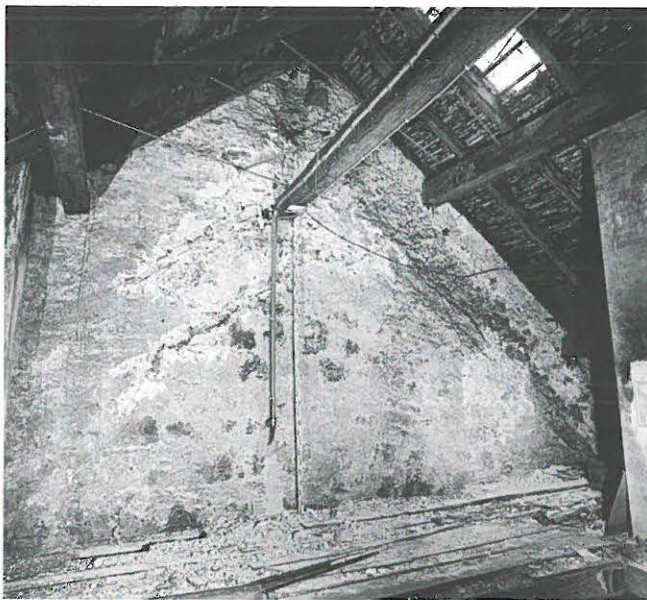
Nidau, Hauptstrasse 17. Übersicht im Dachstuhl nach Nordosten.
